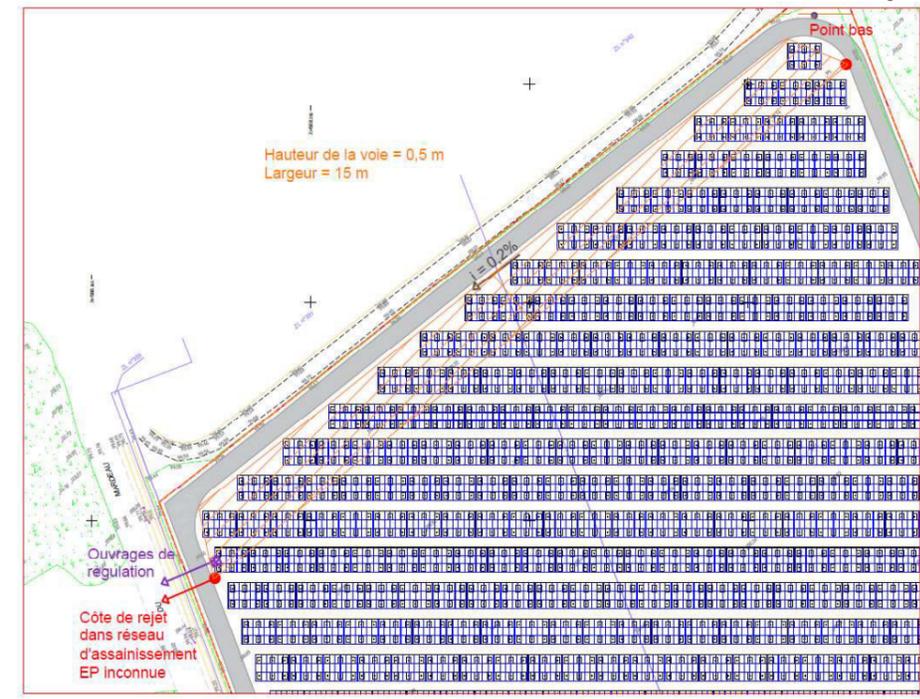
Positionnement des noues selon l'emprise retenue pour un débit trentennal (Source : GINGER BURGEAP sur fond de plan d'URBASOLAR)
